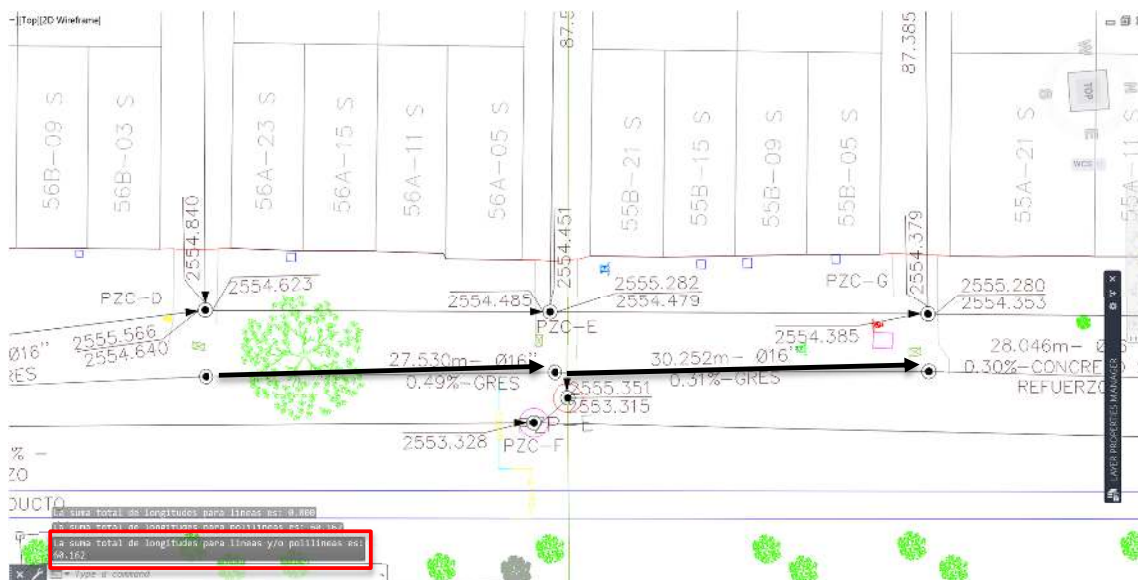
Cuantificación de longitud alcantarillado pluvial D450mm.
